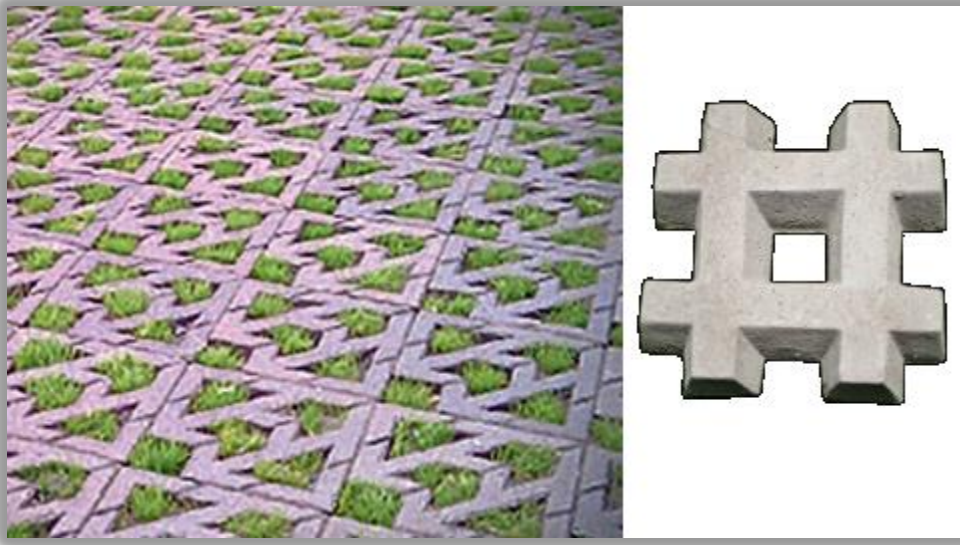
Pavimento de ladrillo cribado y bloque. Fuente: Imágenes Google
